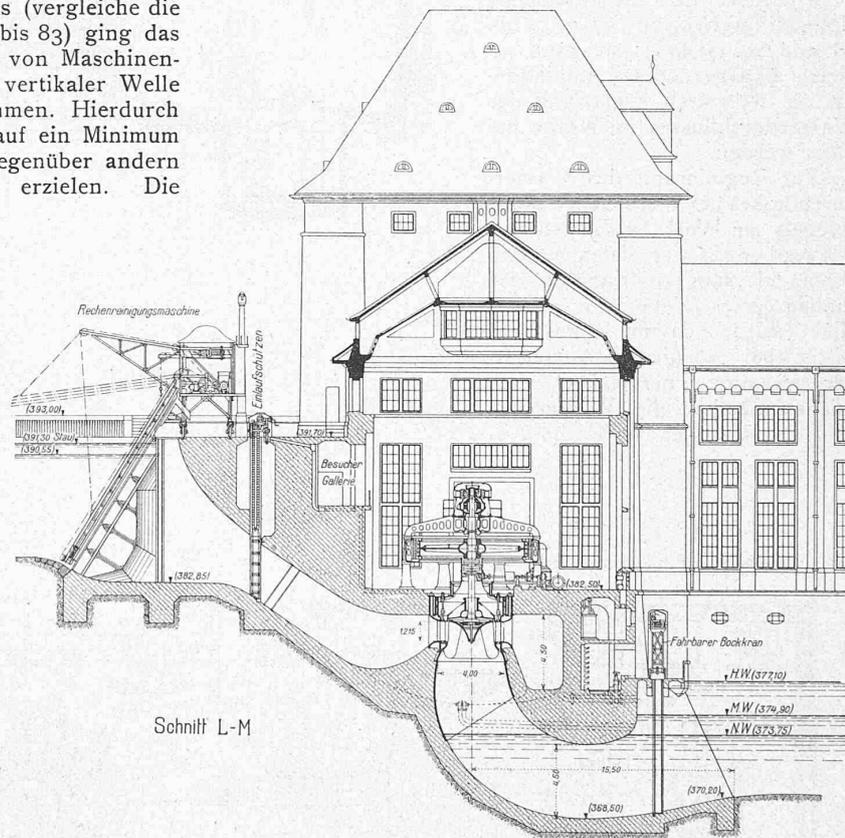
Maschinenhaus des Kraftwerkes Gösgen. — Querschnitt durch Einlauf und Turbine. — 1:400.
